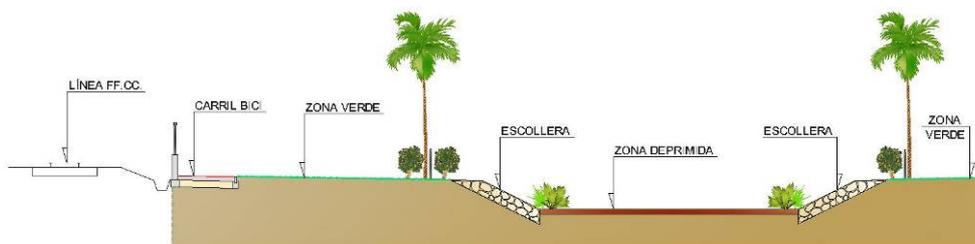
Sección tipo de proyecto del Parque Apeadero.
